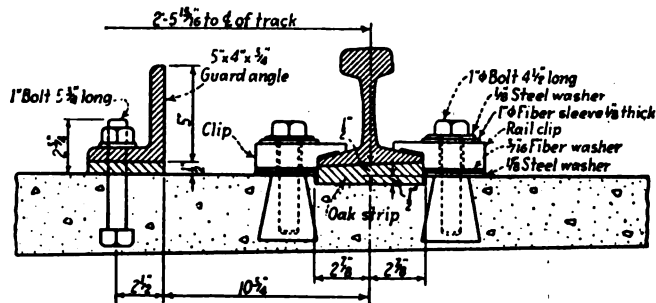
Particolare dell'ancoraggio delle rotaie.
